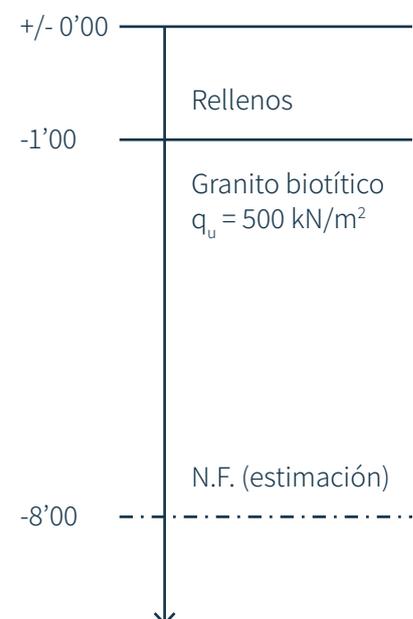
Corte geotécnico del terreno. Elaboración propia.
